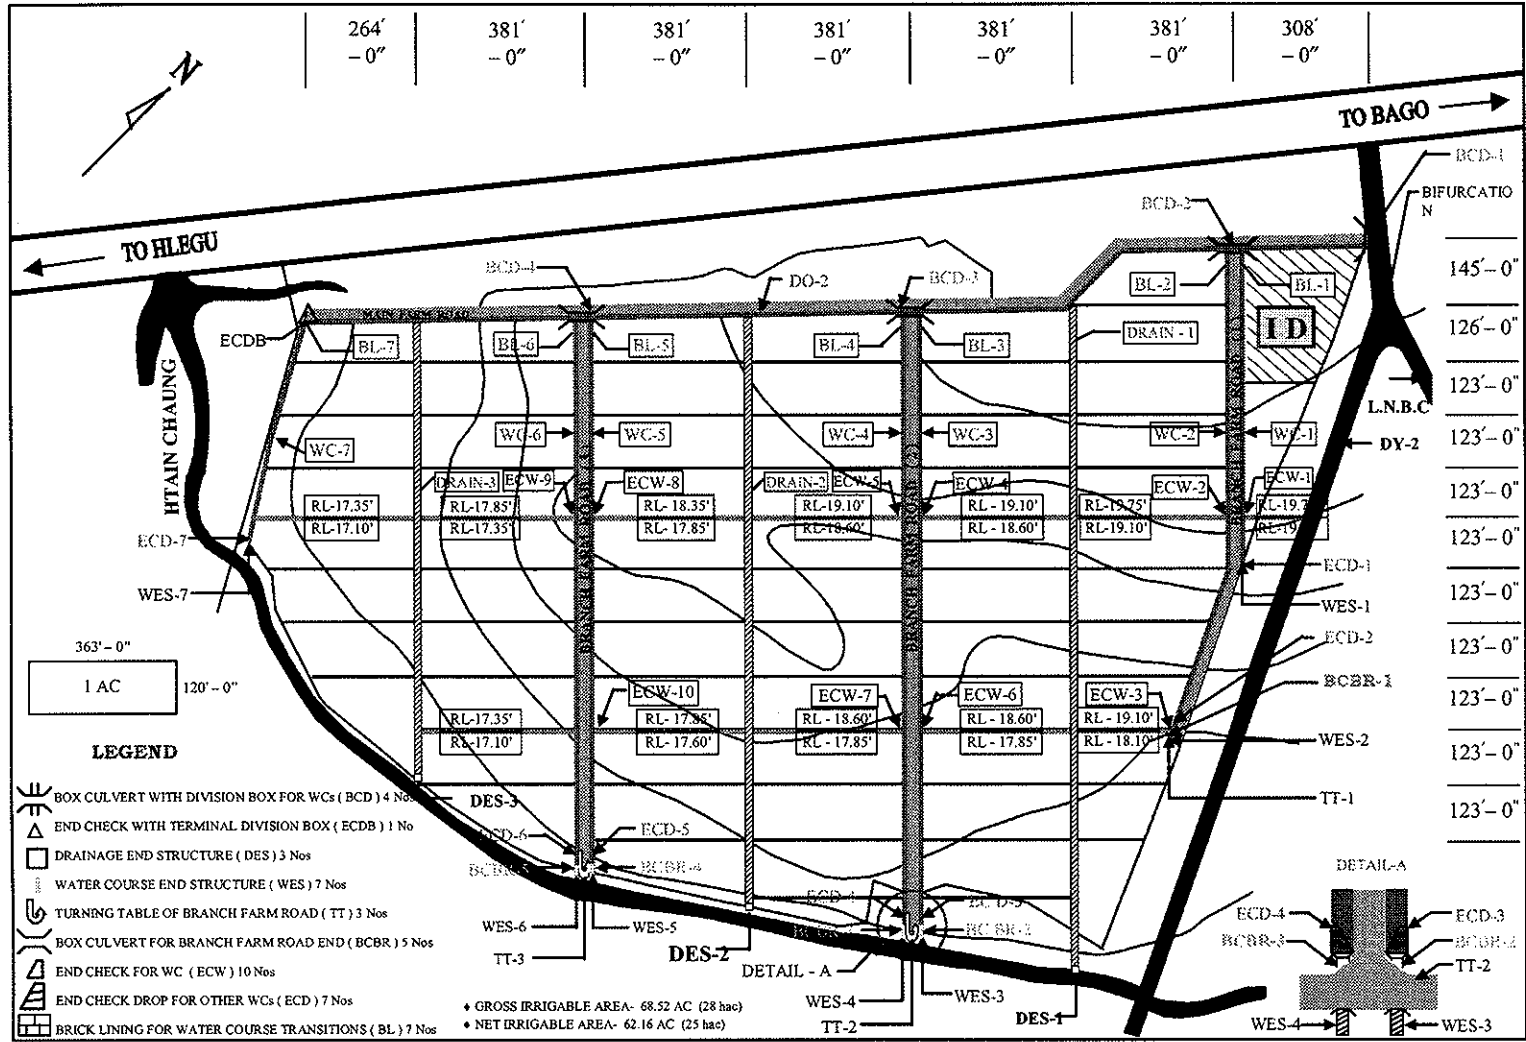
2 試験圃場概要 (インテンシブタイプ)
